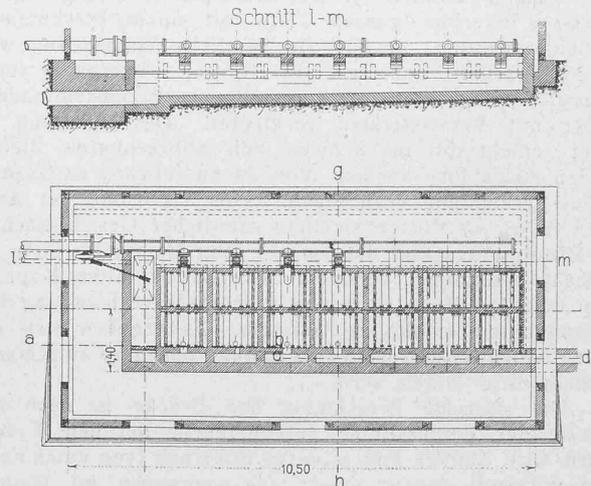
Grundriss und Schnitt des Filterbassins. — 1 : 150.
